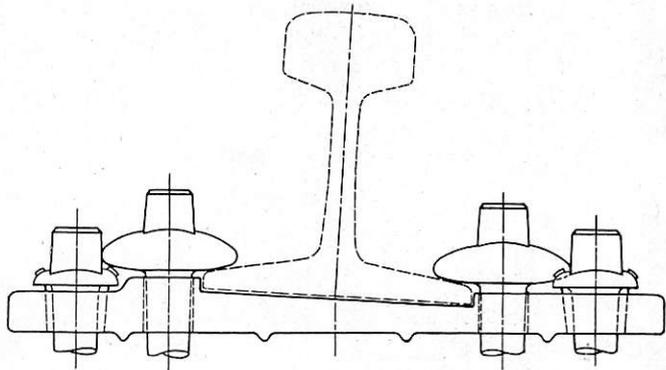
Williams American Unterlegplatte mit Pilzkopfschraubenbefestigung. Gesamte Breite: 36,83 cm.
